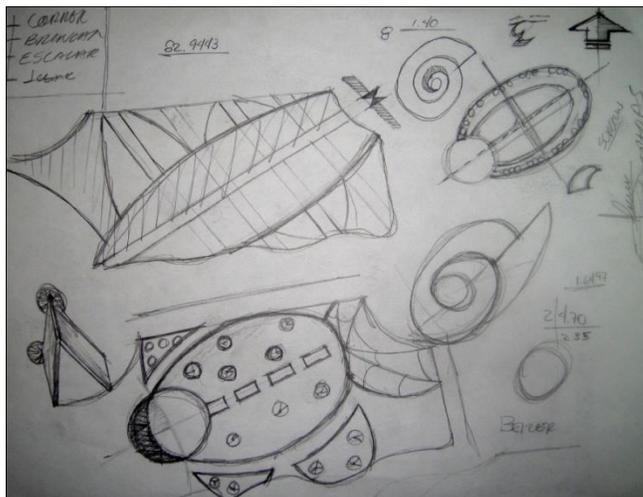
Área infantil. Fuente: Archivo Propio. S/E.
